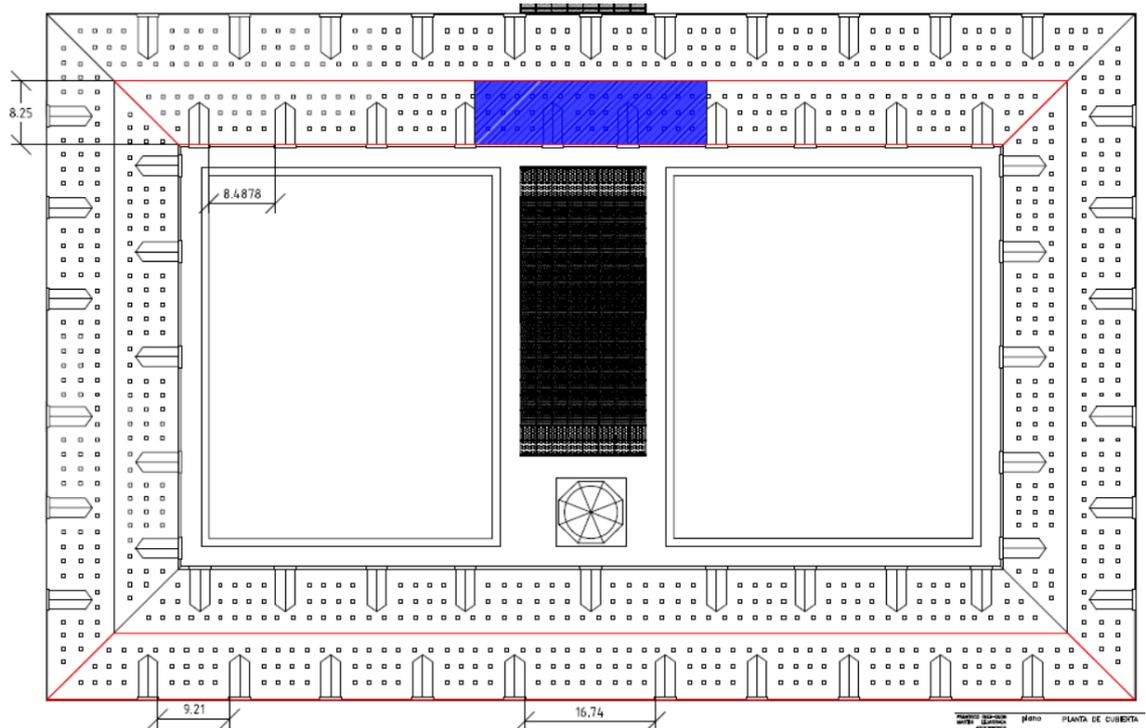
Plano de colocación de paneles fotovoltaicos.
